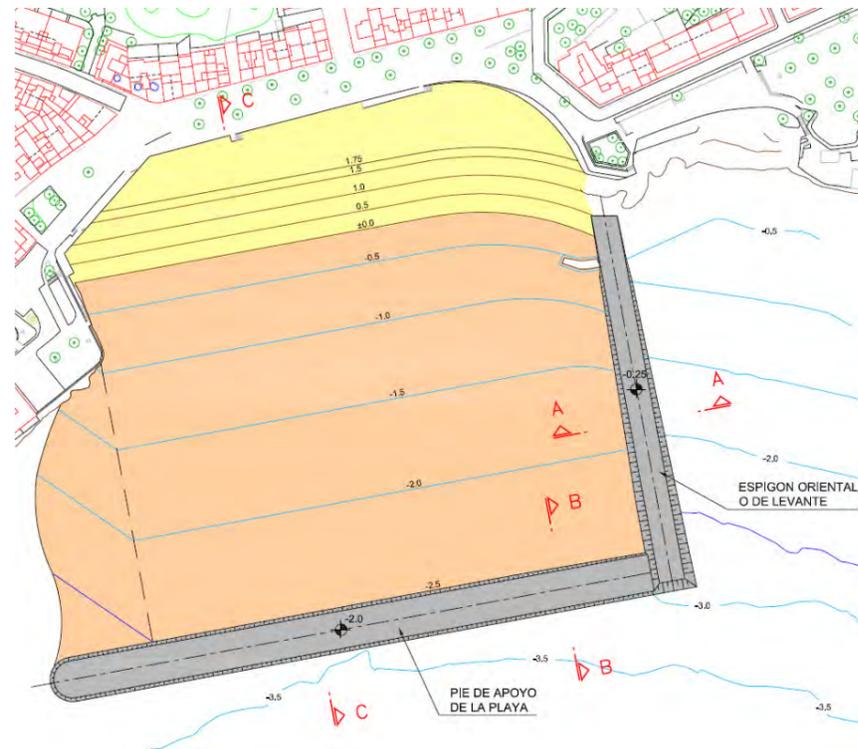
Planta de la Alternativa 2. (Fuente: Elaboración propia)
